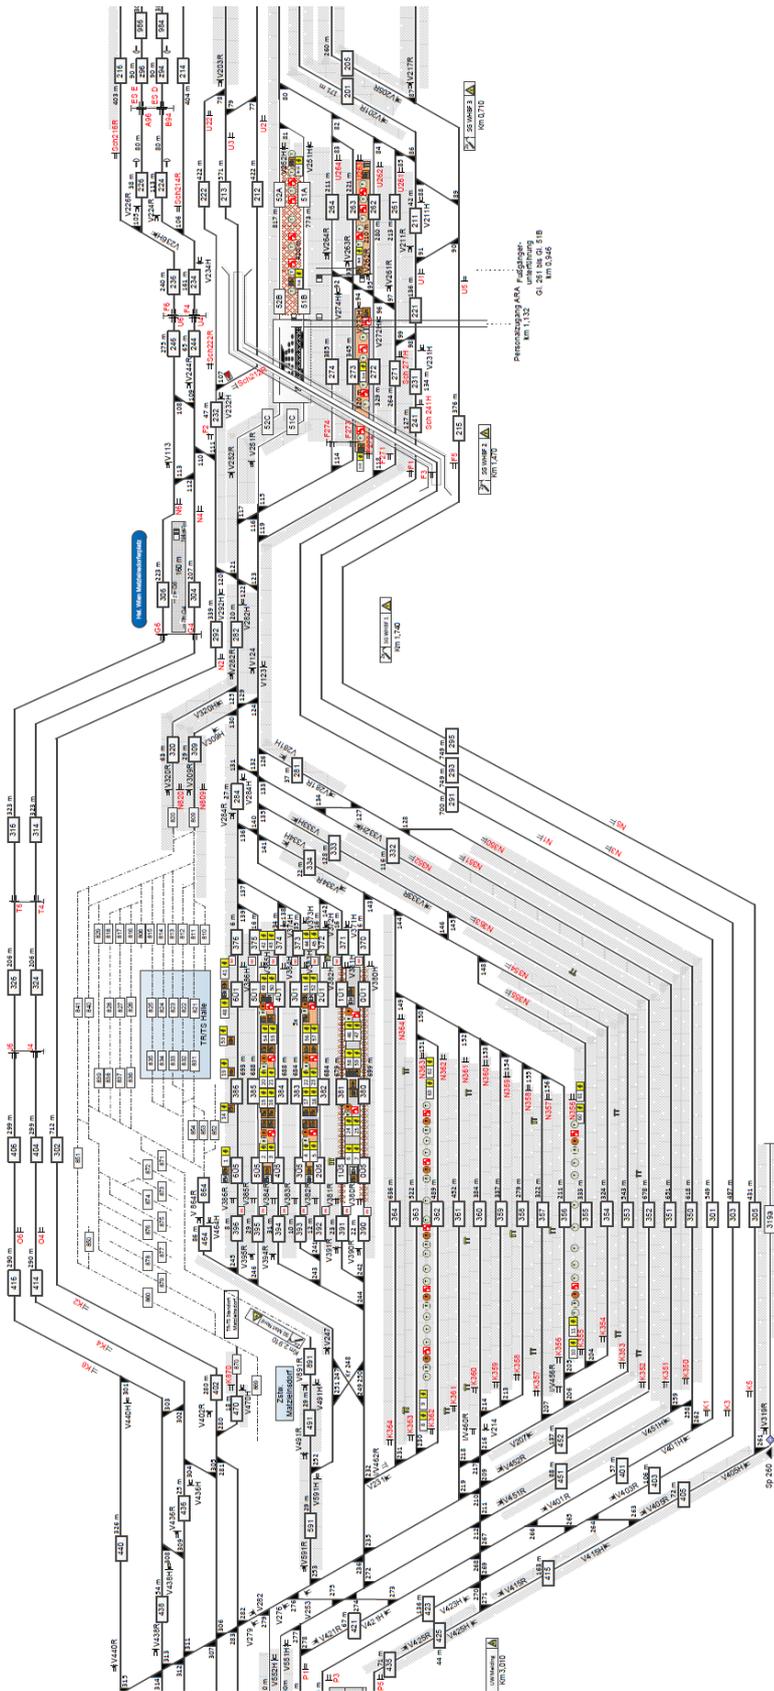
Lageplan Wien Hauptbahnhof
